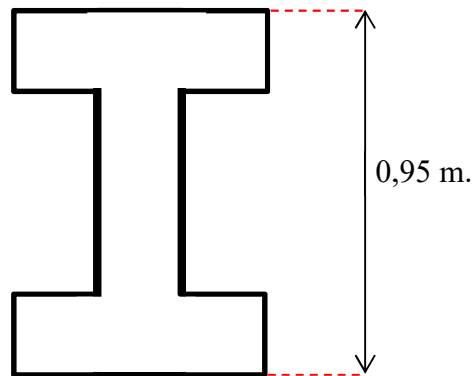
Ficha de reconocimiento de un puente rellenada. Detalles vigas
